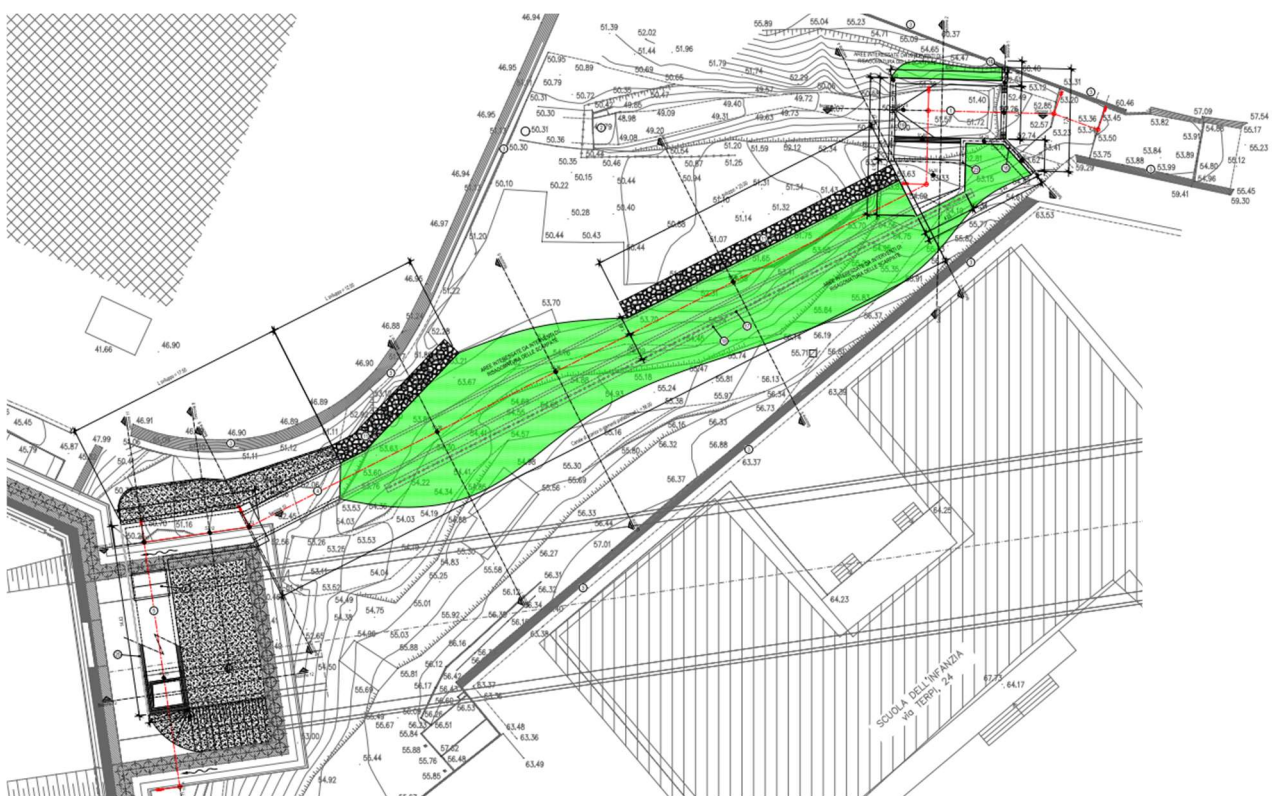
Schema planimetrico degli interventi in progetto sul rio Sciorba.
